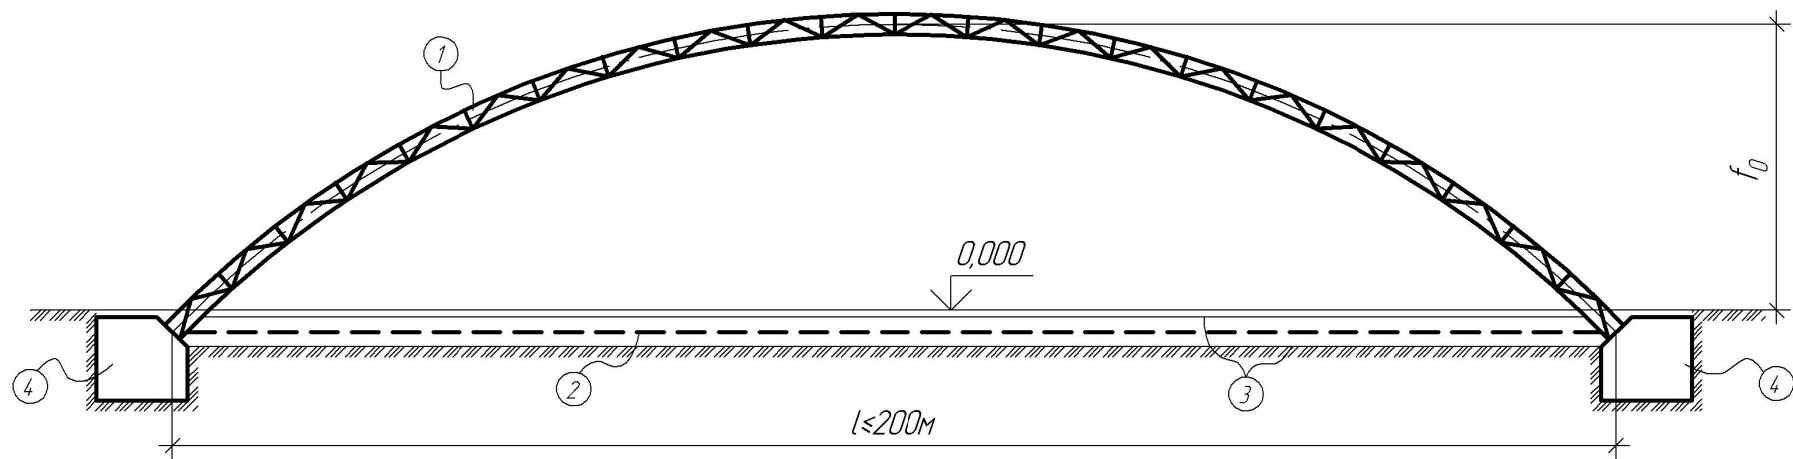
Большепролетное здание с арочным покрытием с затяжкой в коробе ниже отметки пола: 1 – арка большепролетная; 2 – затяжка; 3 – короб для затяжки; 4 – фундаменты;  $f_0$  – стрела подъема;  $l$  – пролет
